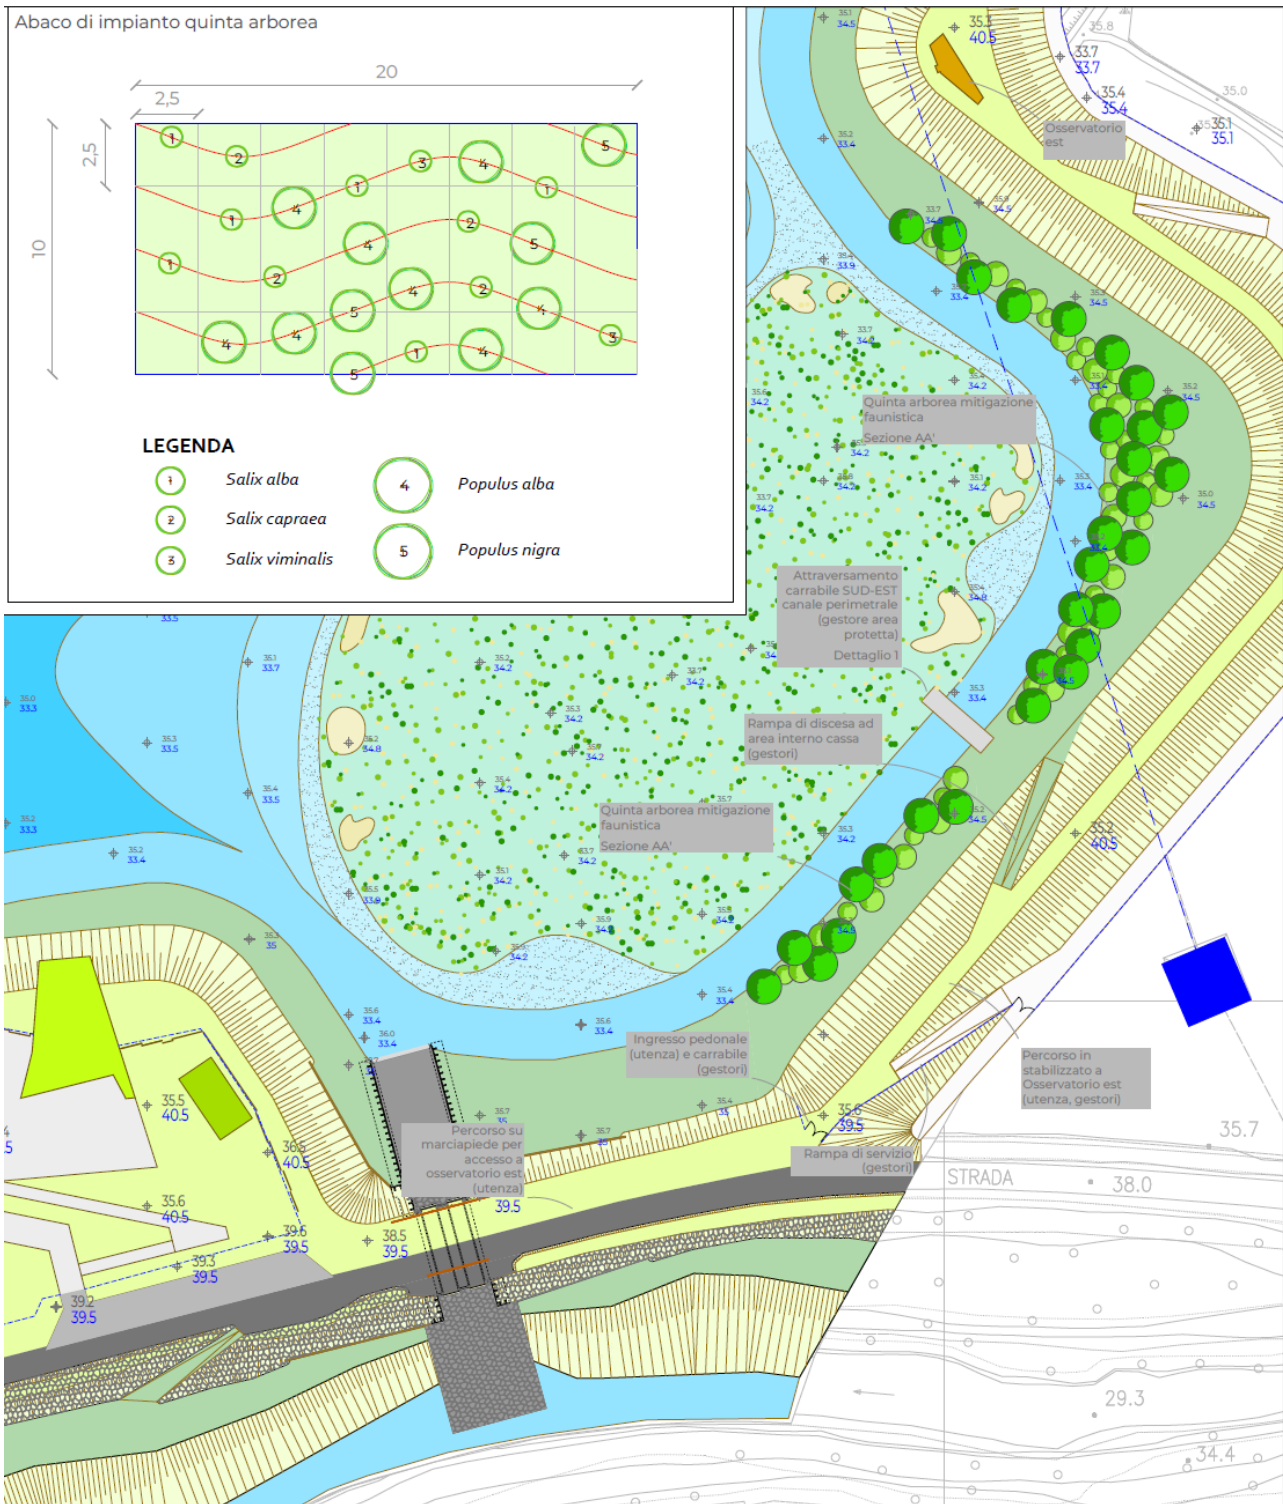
Planimetria generale dell'accessibilità all'osservatorio est
